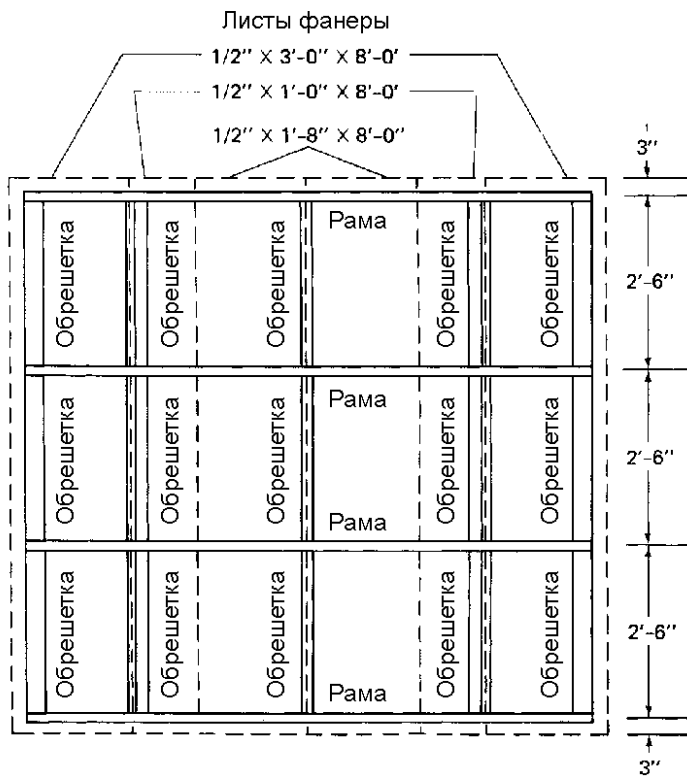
План рамной конструкции крыши (ТЕСО)
